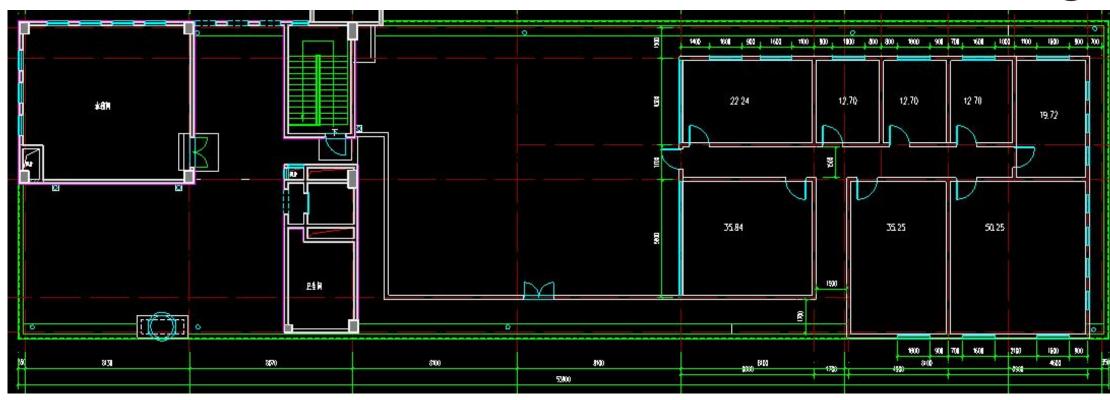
1#楼楼顶平面布置图 (1:100)
